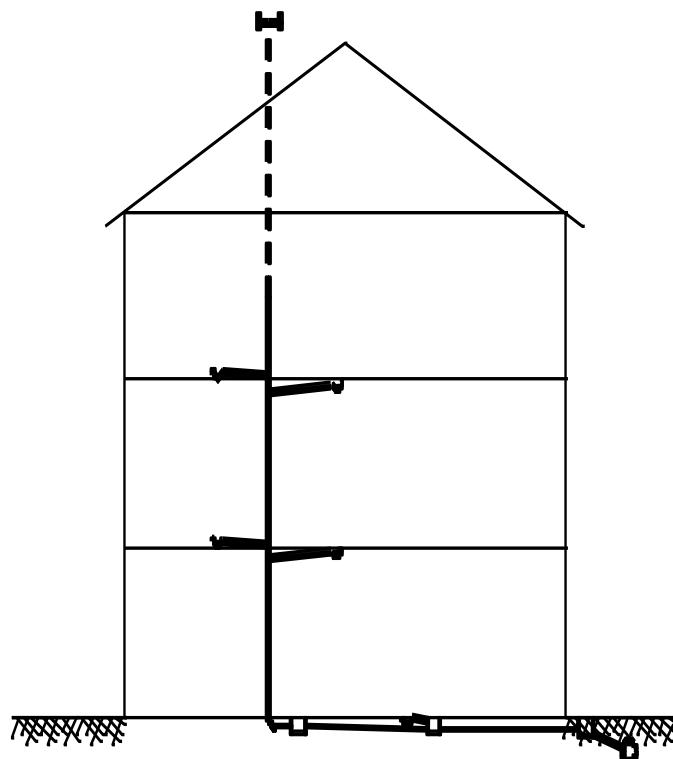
Sistema de drenagem predial sem ventilação secundária e sem elevação
